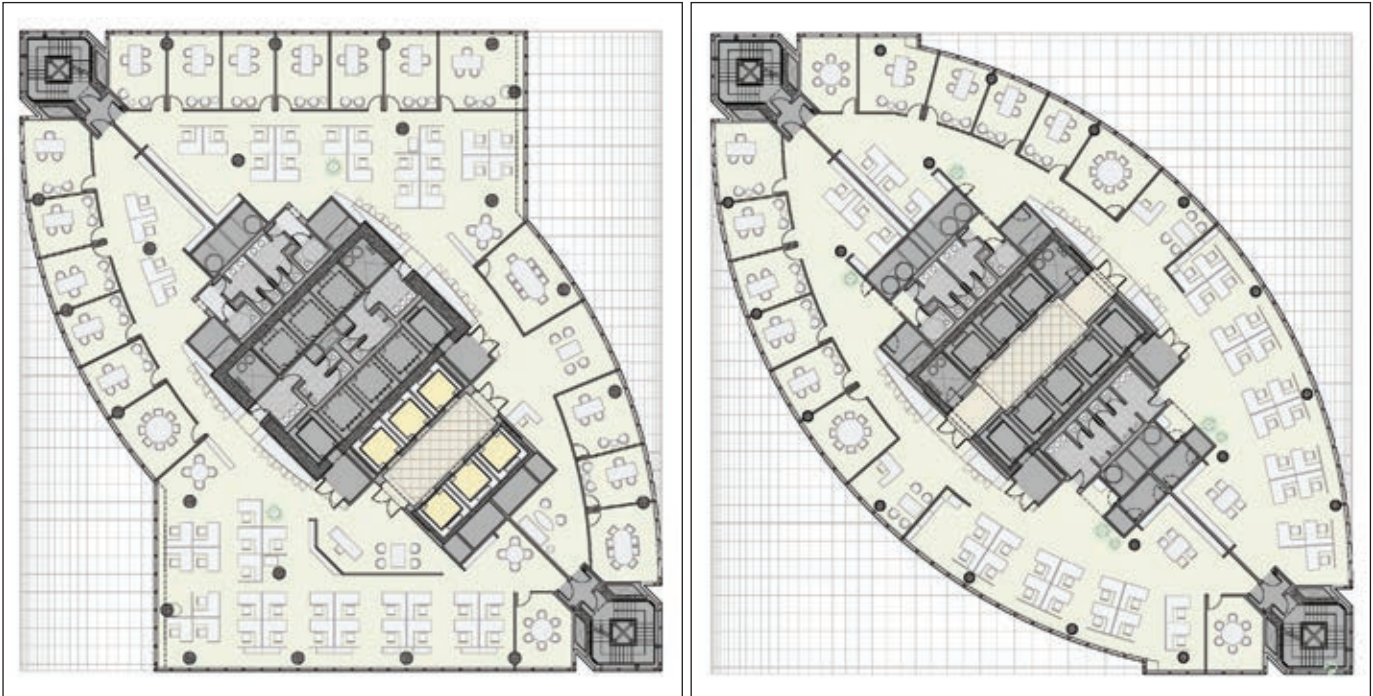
Plantas tipo de oficinas en las diferentes zonas del edificio.
